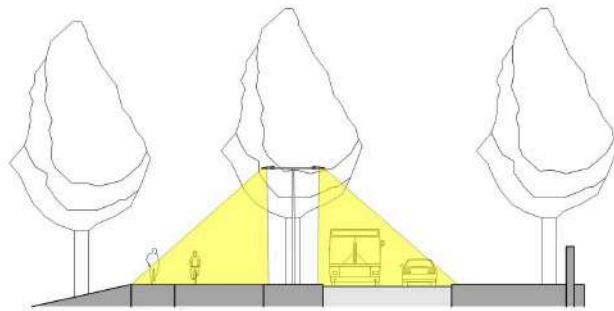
Schnitt B1 der Planstraße A basierend auf dem städtebaulichen Entwurf
